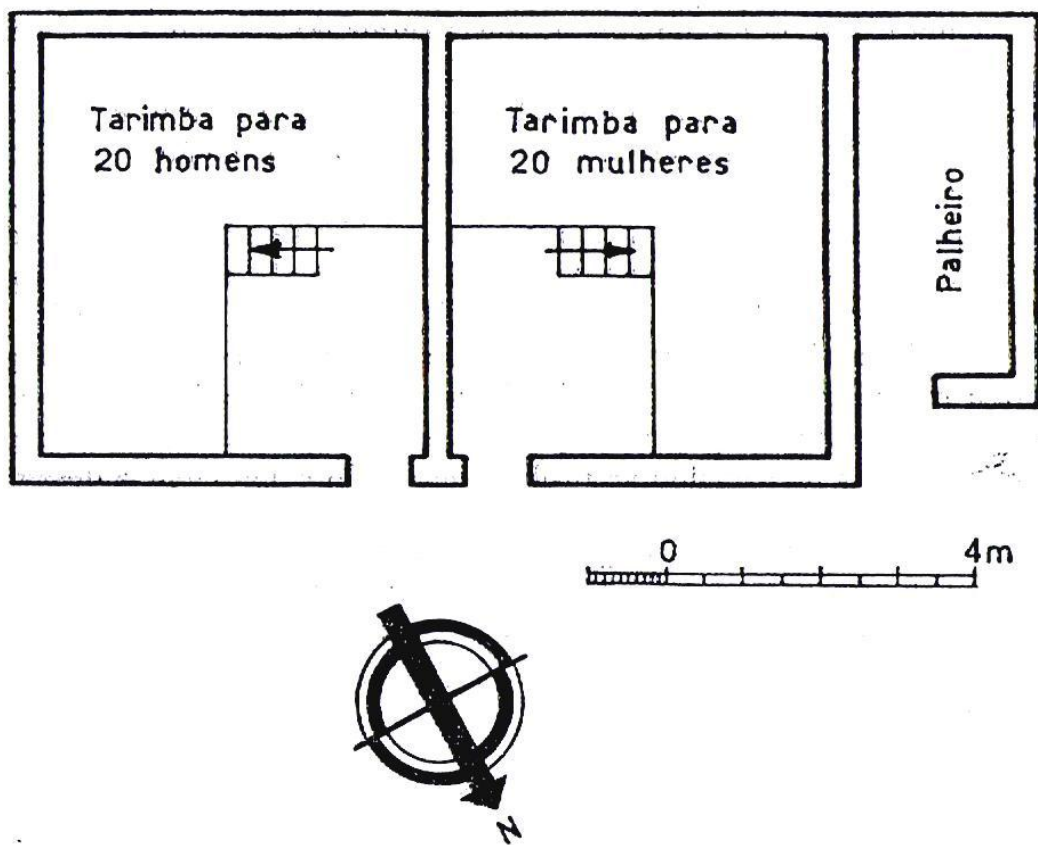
Casais do Douro – Exemplo n.º 34. Planta do Cardenho
